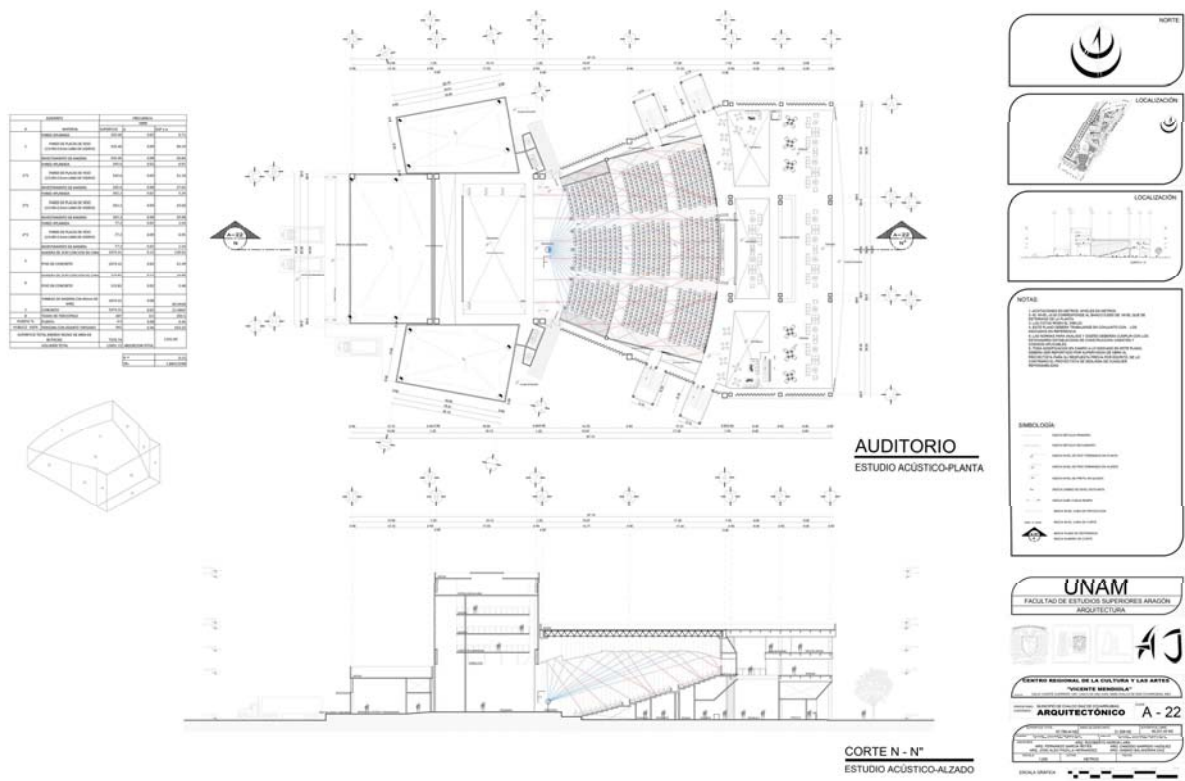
PLANO ARQUITECTÓNICO – ESTUDIO DE ACÚSTICA – A-22. Fuente: Elaboración propia.
